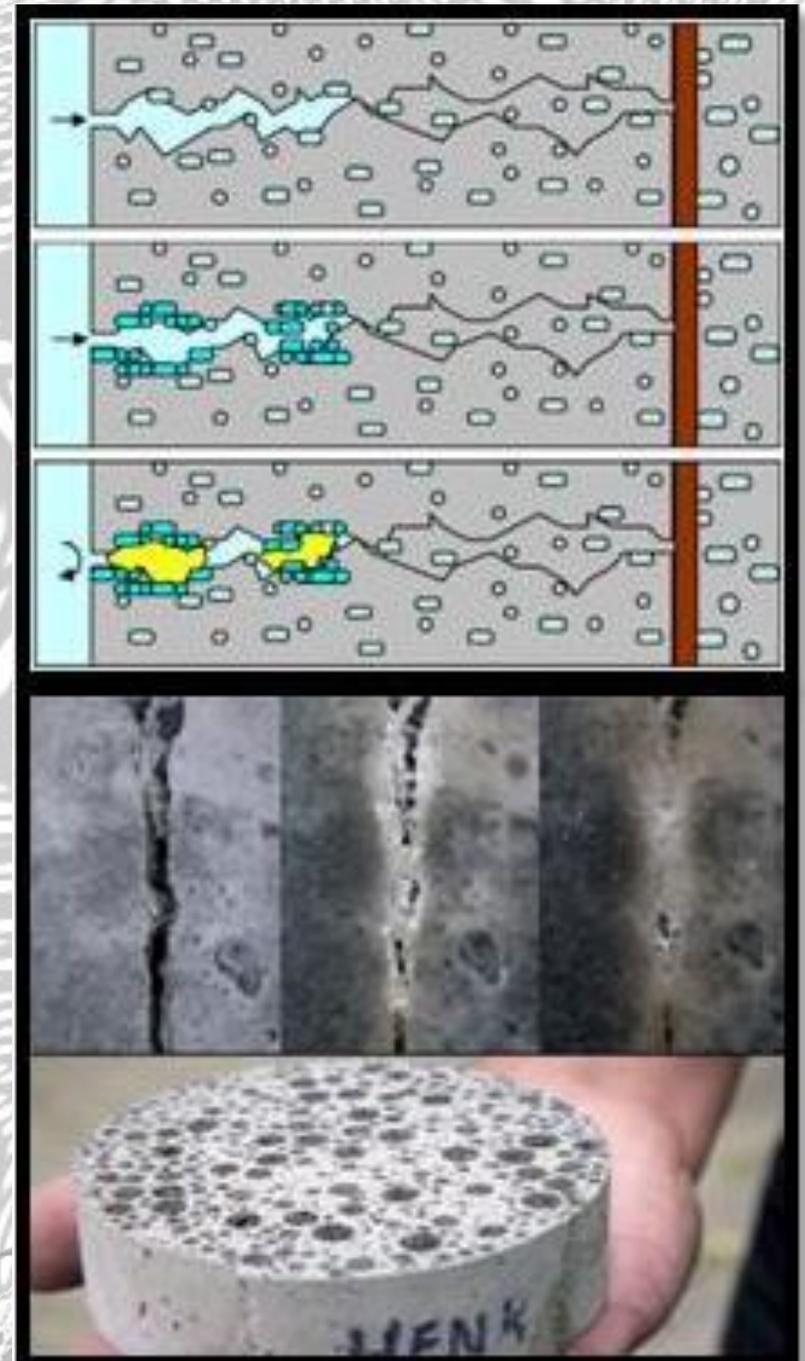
proceso de curado hormigon Concretech (CONCRETECH, 2012).
